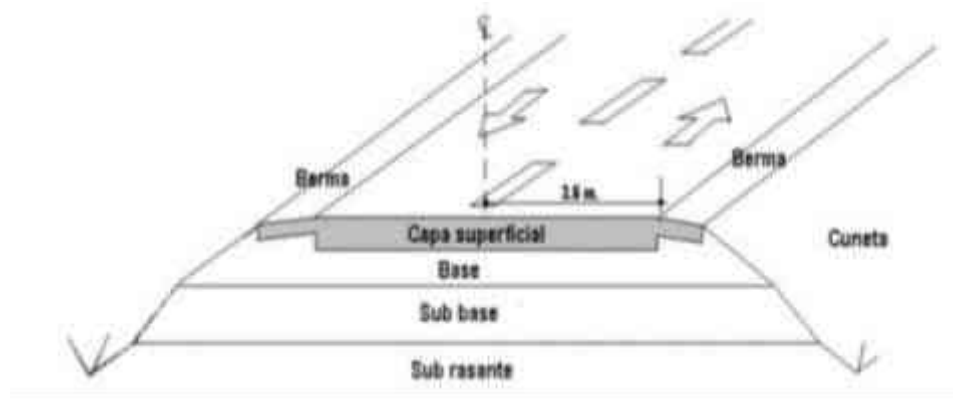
Estructura típica de un pavimento asfáltico (flexible)
